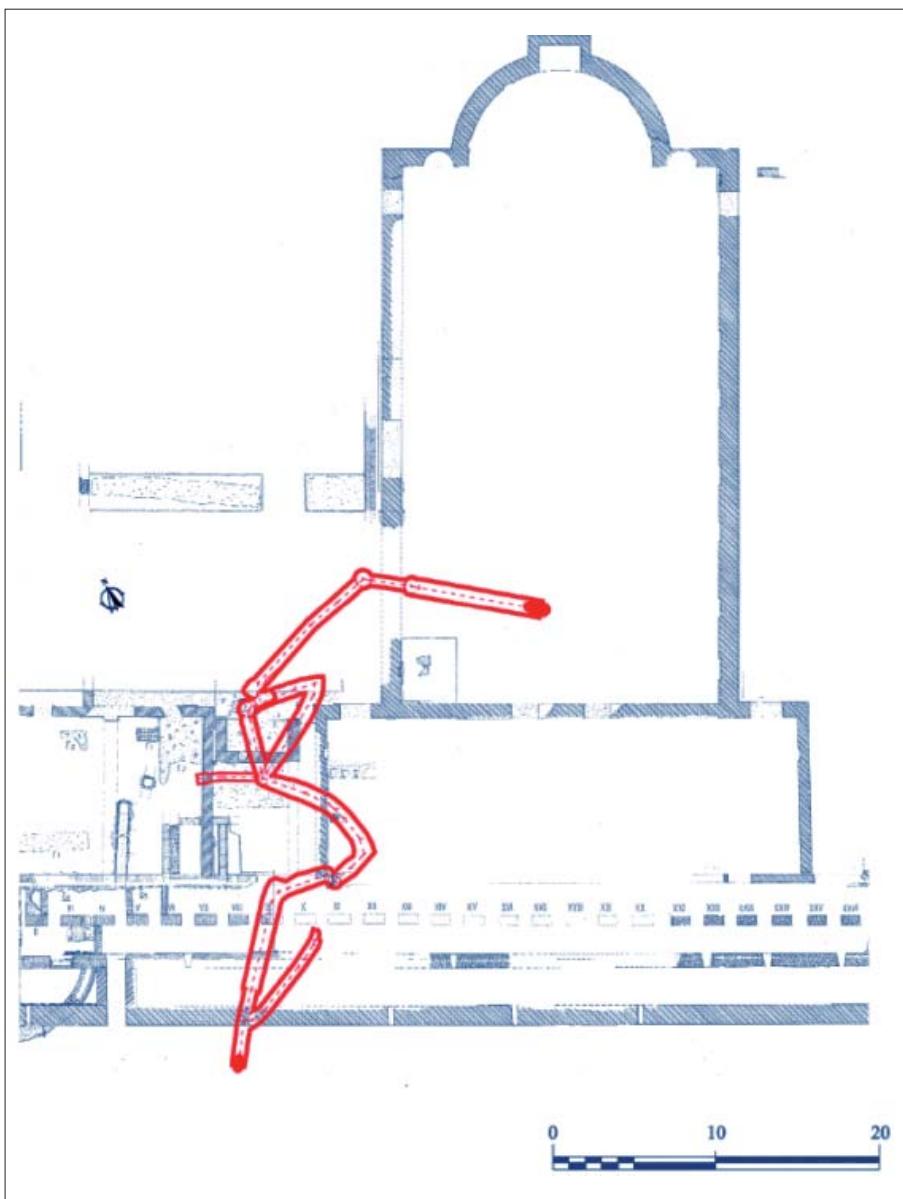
Pianta dei condotti (rilevo a cura di Elettra Santucci e Elena Silvestro in (CAMARDO, GIRARDO, LORETI 2017) e sovrapposizione con pianta generale di Giovanni Ioppolo (PISANI SARTORIO 2006)
